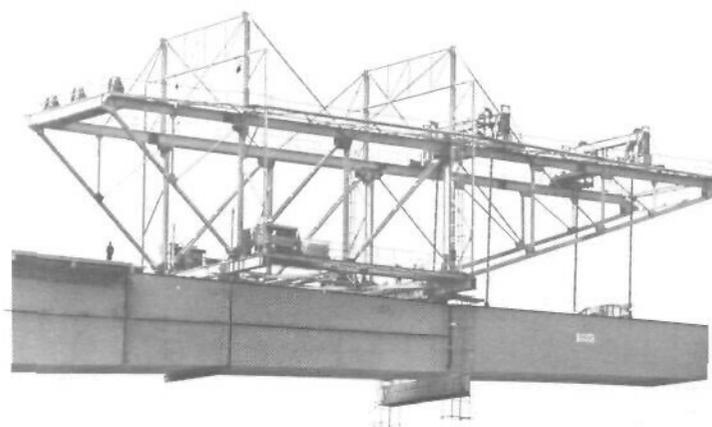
Le tronçon est suspendu à quatre bretelles métalliques constituant en réalité trois appuis, du fait du balancier avant, visible au niveau du platelage supérieur.
